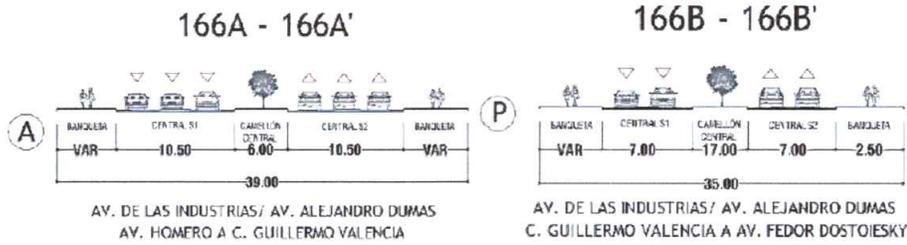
Sección vial actual y futura de la Av. De las Industrias / Av. Alejandro Dumas. Fuente PDU 2040 vigente.
